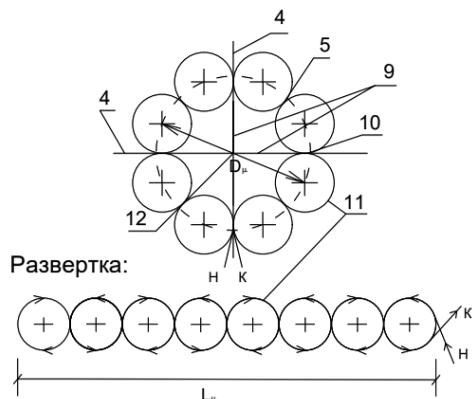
Круглая вязаная сетка из арматурного стержня с круглыми отгибами: 4 – фиксаторы сетки; 5 – электроприхватки; 9 – соединительные стержни крестовины; 10 – точечная сварка; 11 – арматурный стержень (проволока) с круглыми отгибами ( $m = 8$  шт.); 12 – средний диаметр  $D_{\mu}$ , мм;  $L_c$  – длина круга со средним диаметром, мм
